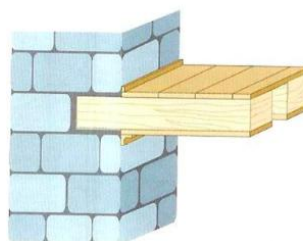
Apoio de viga de madeira em alvenaria de pedra [1]
